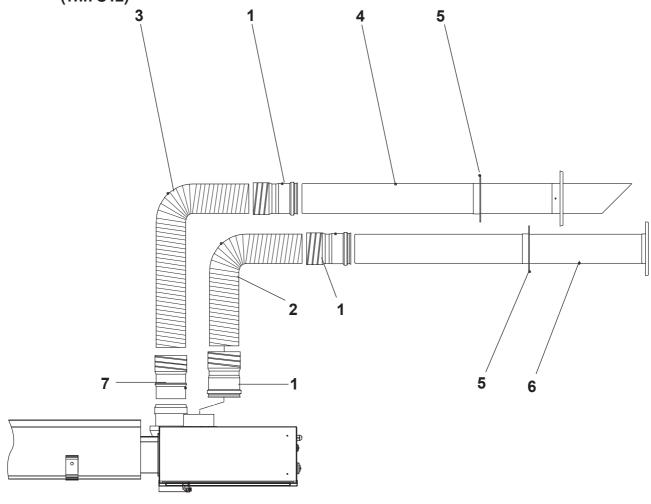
Дымоудаление и ввод воздуха через стену в отдельных трубопроводах (тип С12 Таб. 6.1 деталь В)
